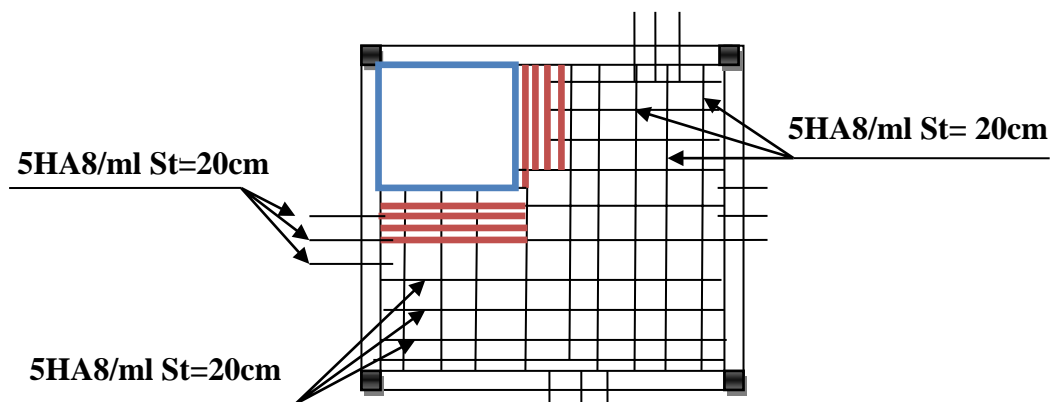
Schéma de ferrailage dalle sur de04appuis(D3)
